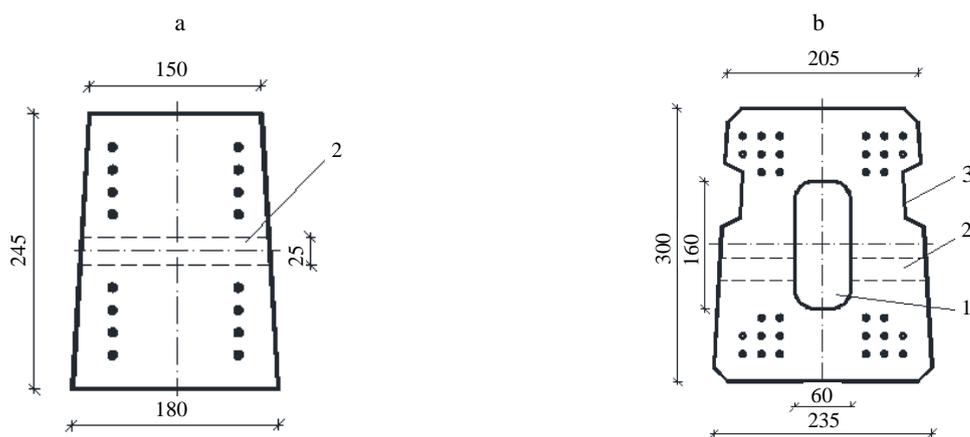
Поперечные сечения стоек стендового безопалубочного формования для опор воздушных линий напряжением 0,4–10 кВ: а – стойка сплошного сечения; б – полая стойка; 1 – полость; 2 – отверстие для строповки; 3 – паз (используется для первого подъема изделия с поддона стенда специальным грузозахватным приспособлением)
